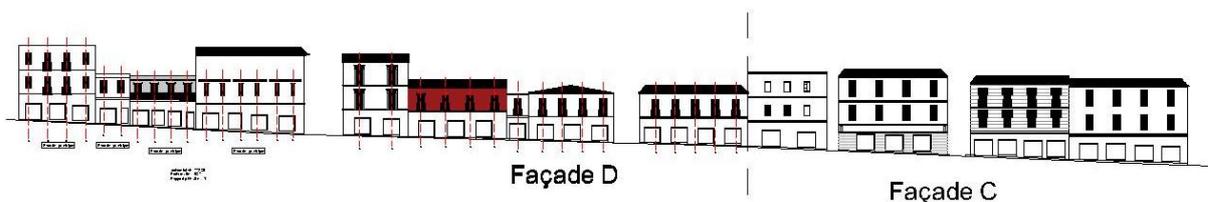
Façade sur la rue Bouras fait par les auteurs
